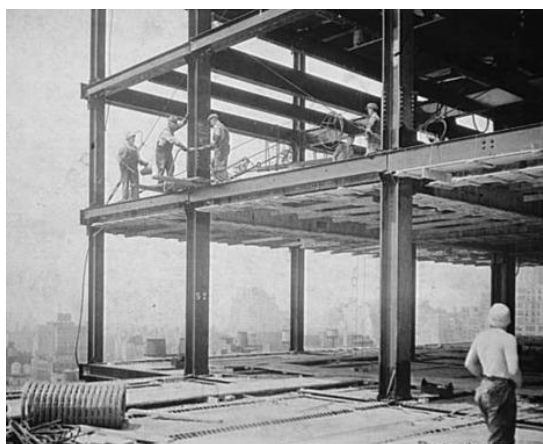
Fotografías de la construcción del *Empire State Building*.
